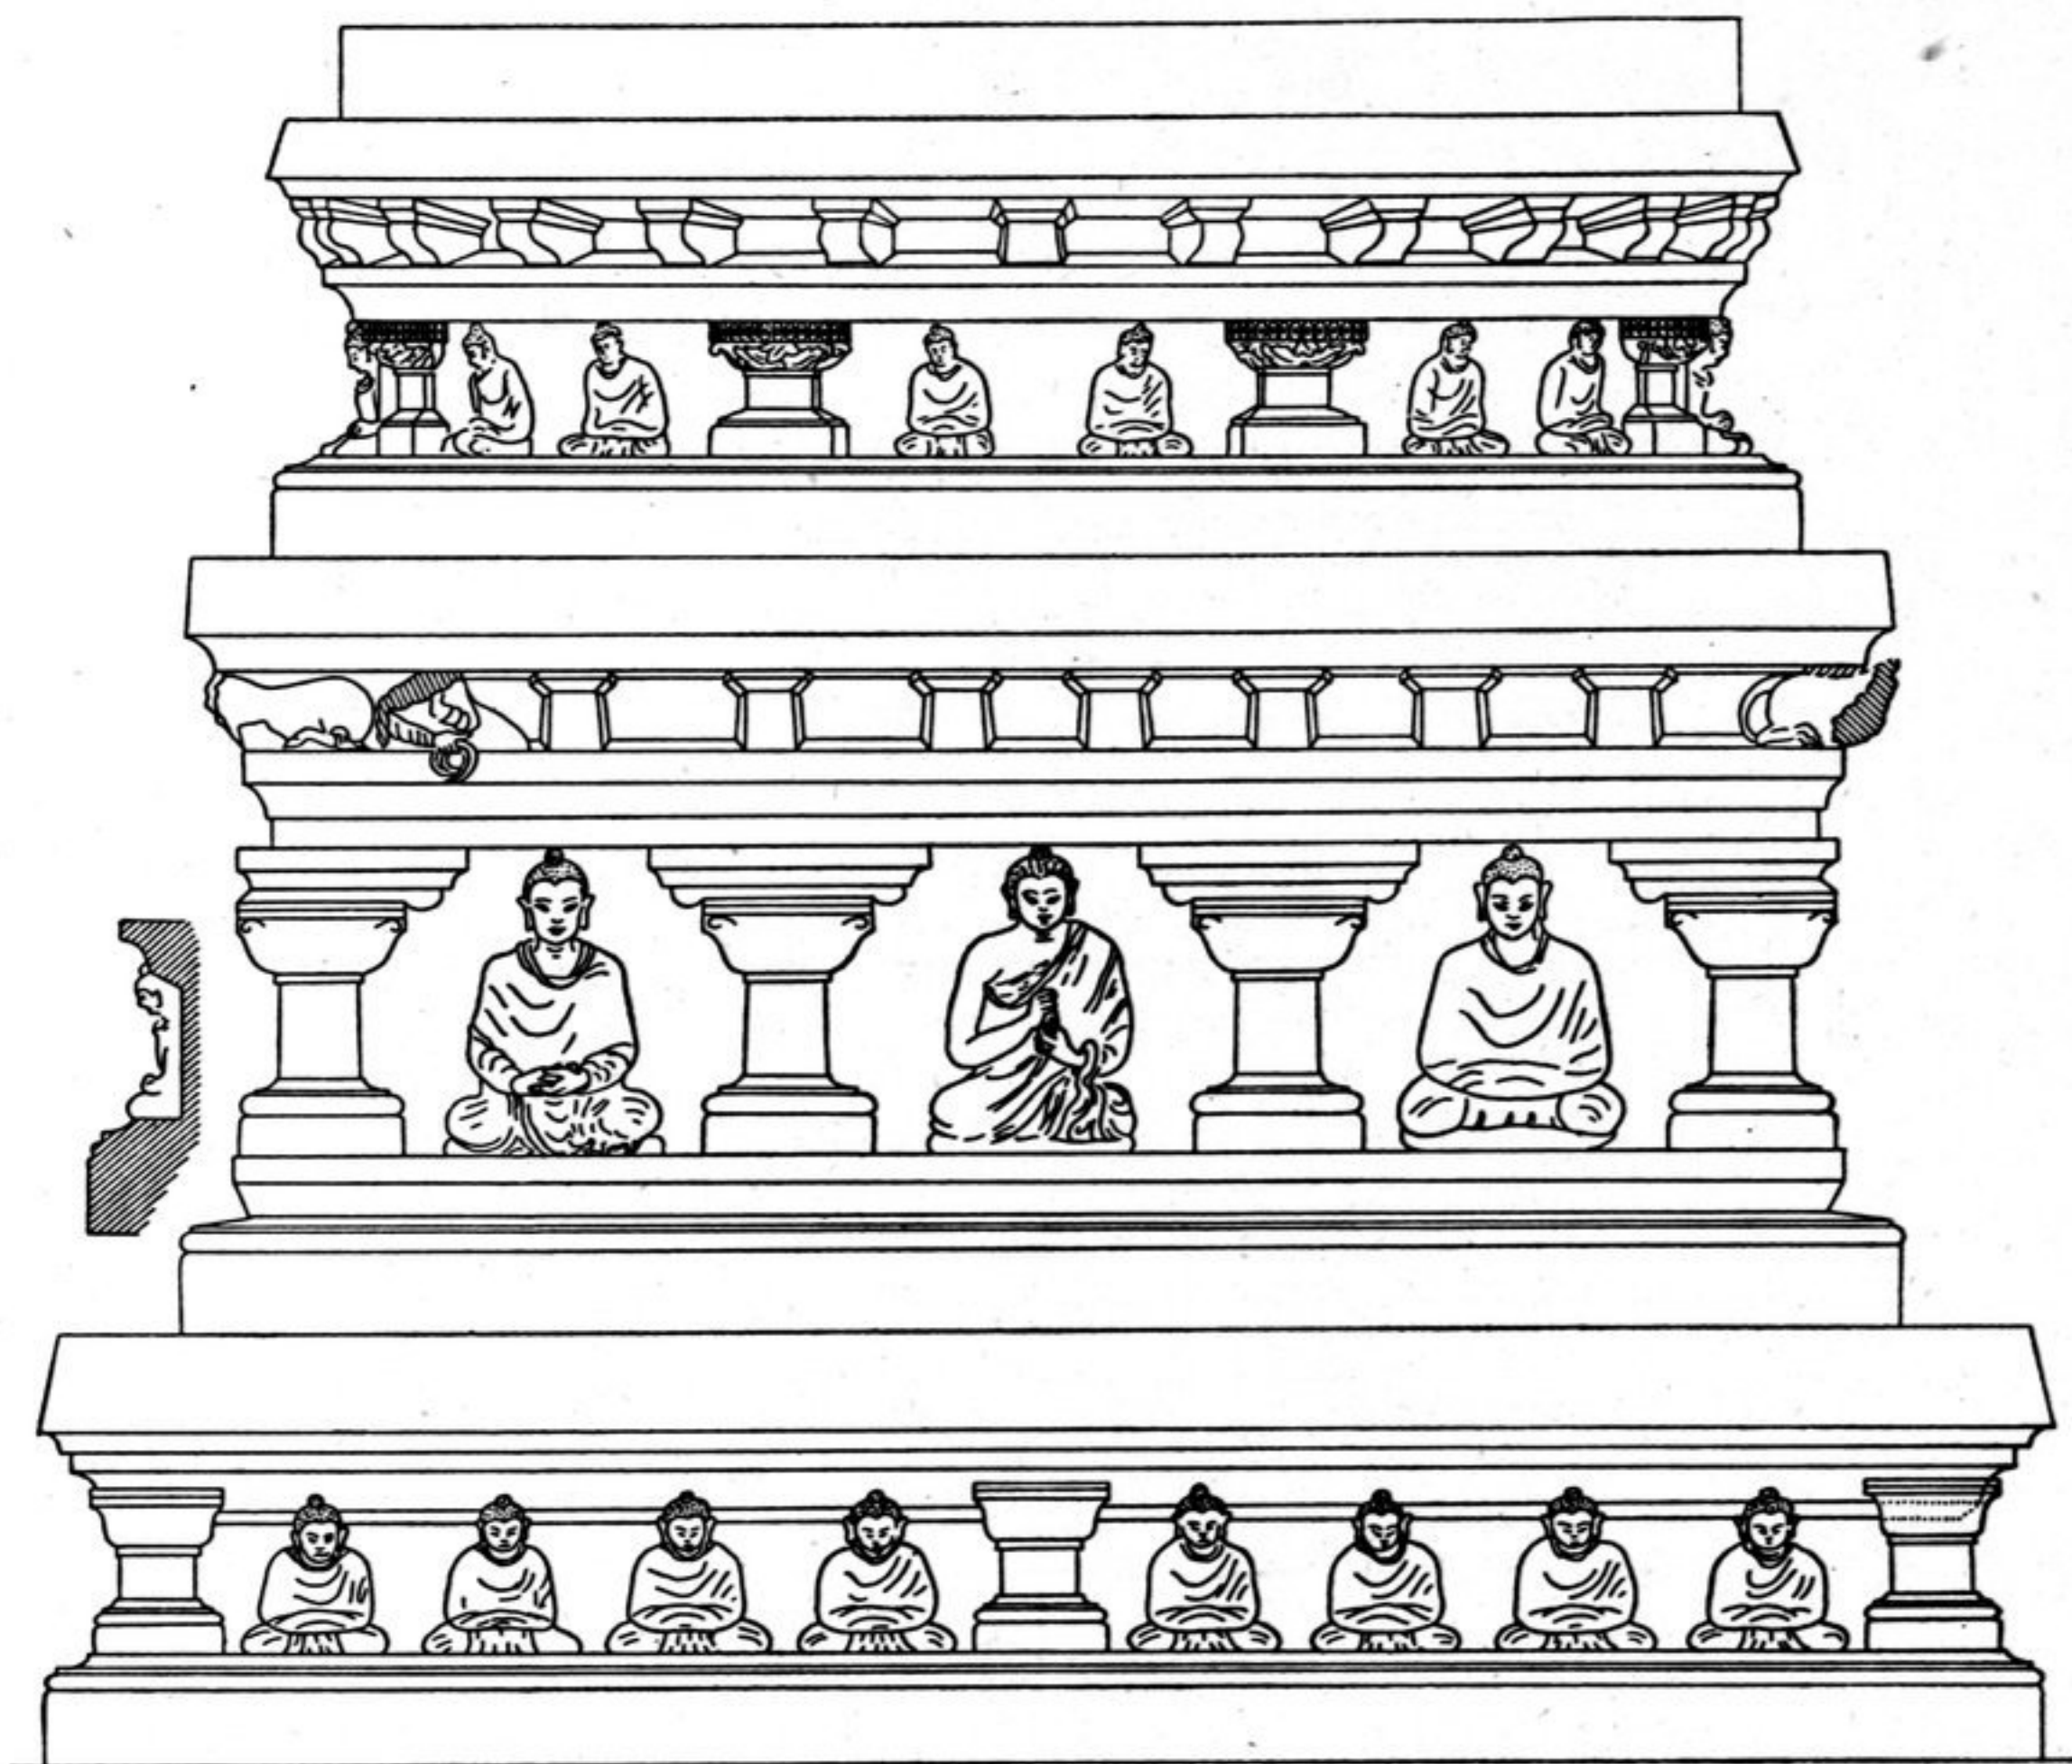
Façade du st. TK, 133 (Éch. 1/10).
